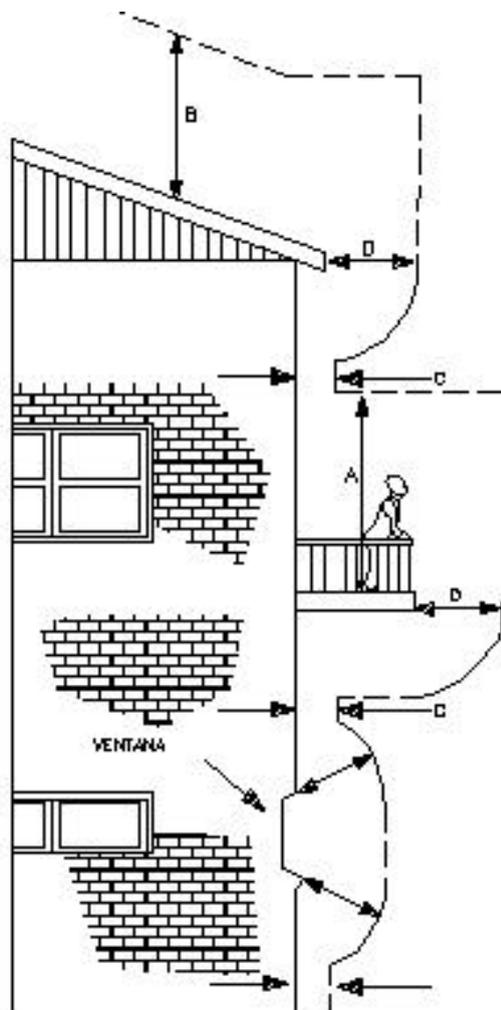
1.- DISTANCIAS DE ESTRUCTURAS
